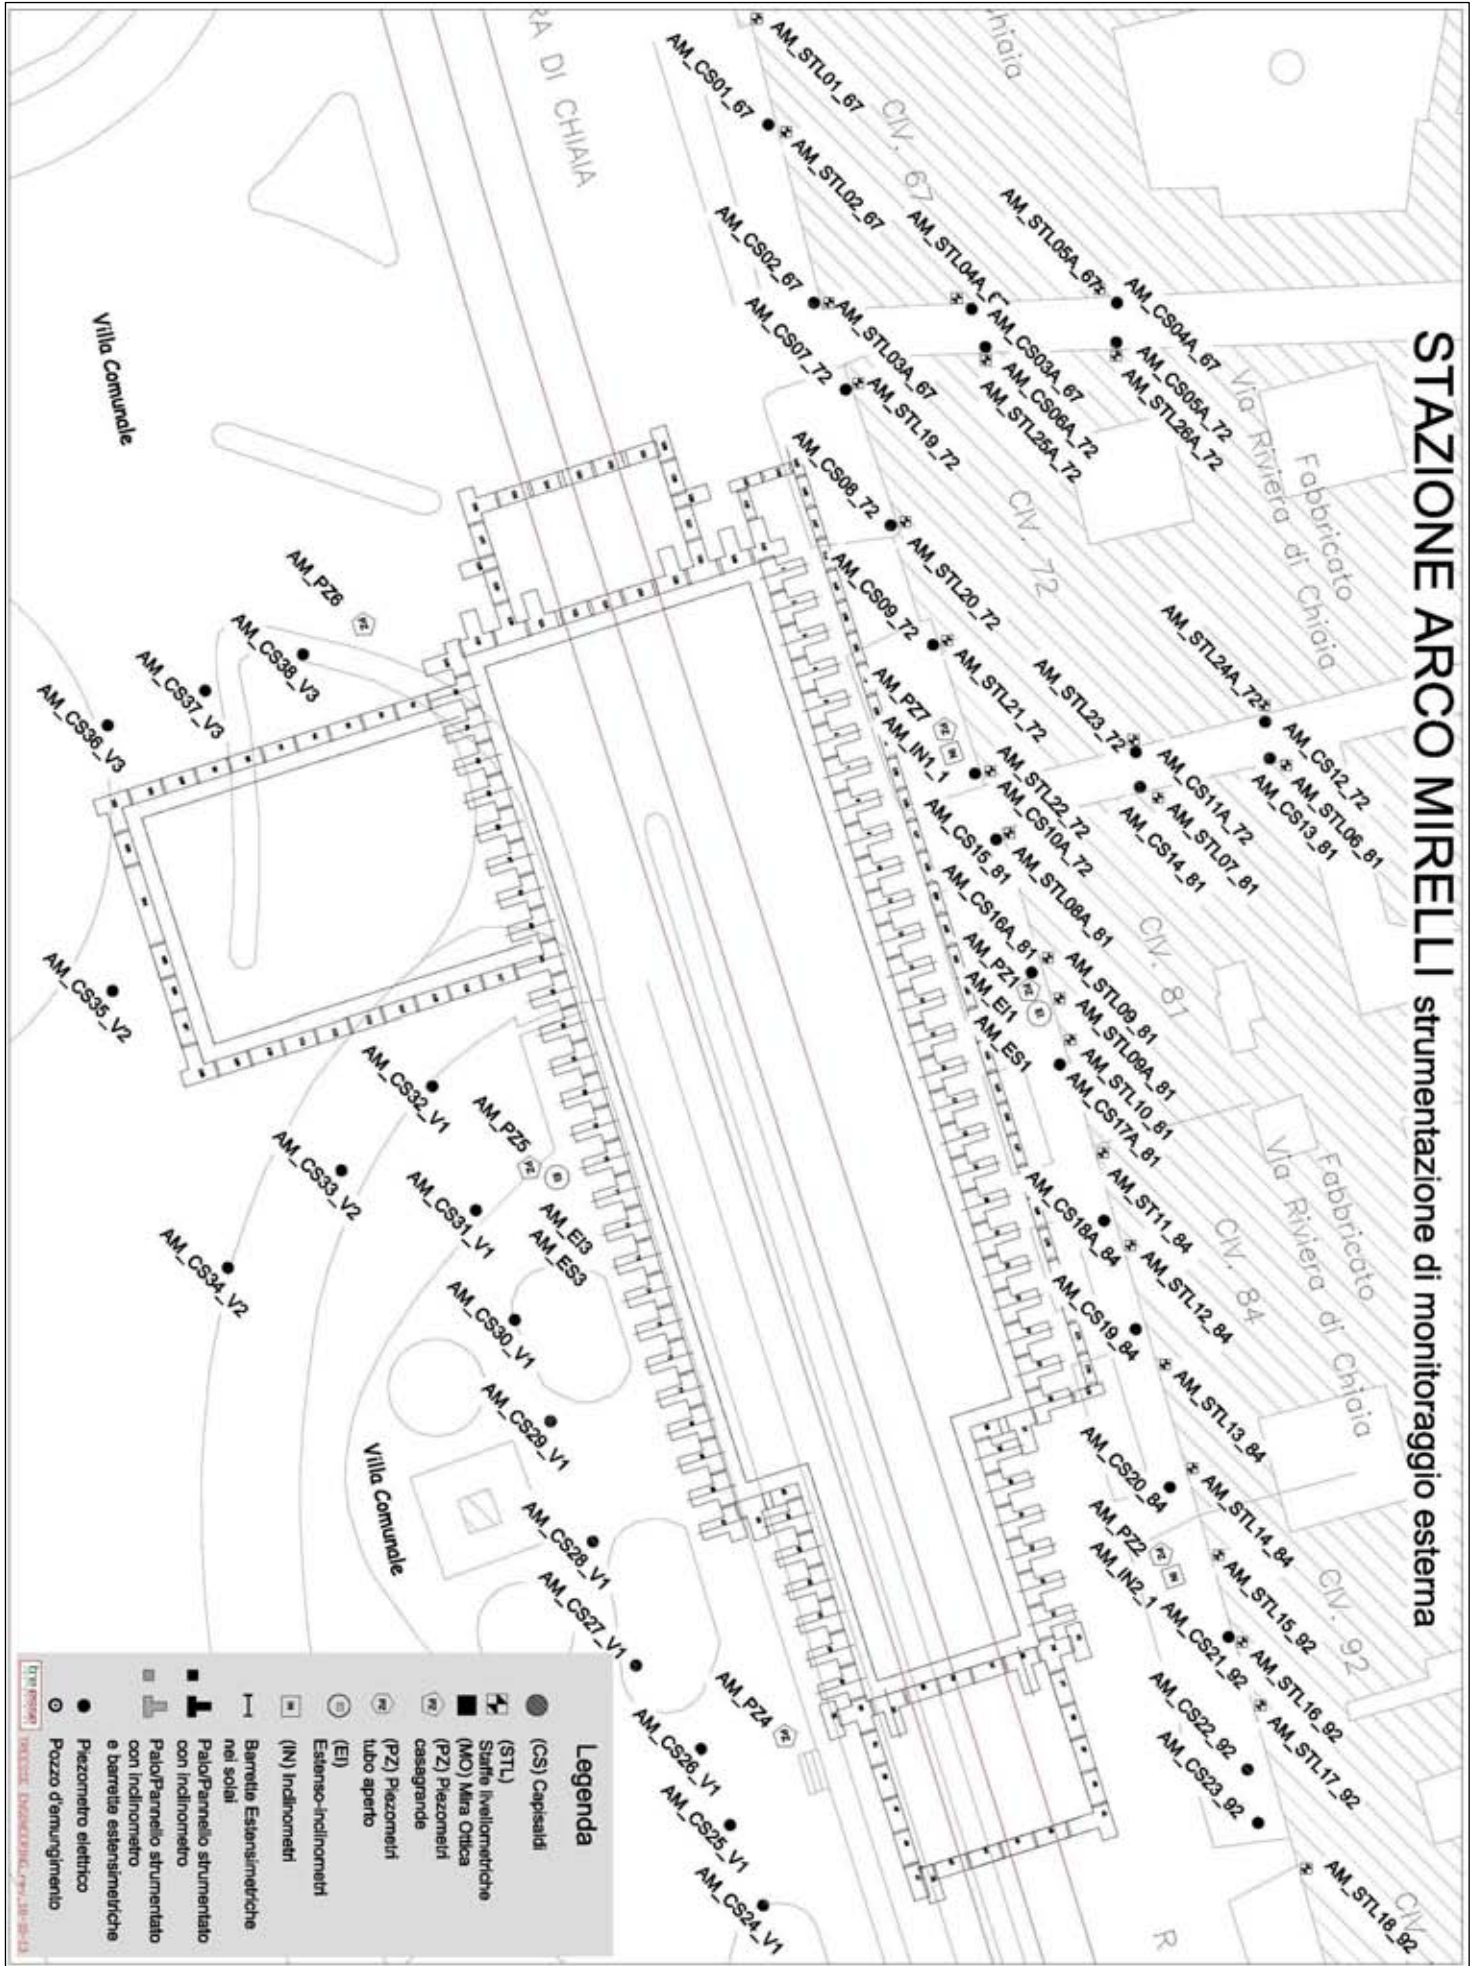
Planimetria pozzo stazione, raffigurante la disposizione della strumentazione di monitoraggio topografico e geotecnico esterna.
